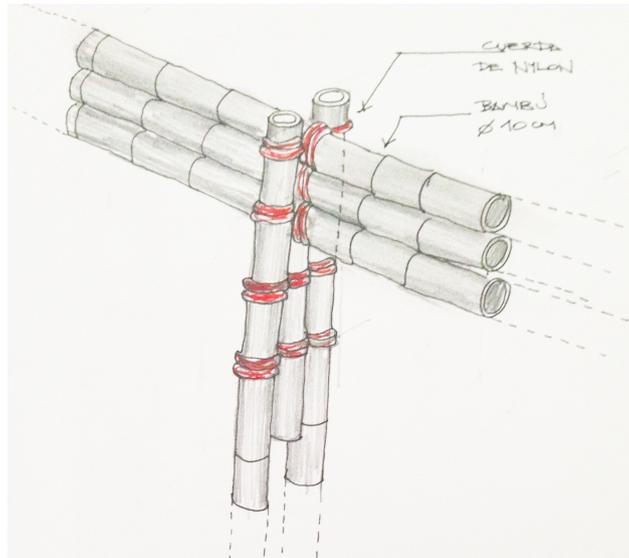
Boceto en el cual se analiza el armado de las vigas compuestas. Detalle del encuentro columna-viga. (Fuente: elaboración propia).
